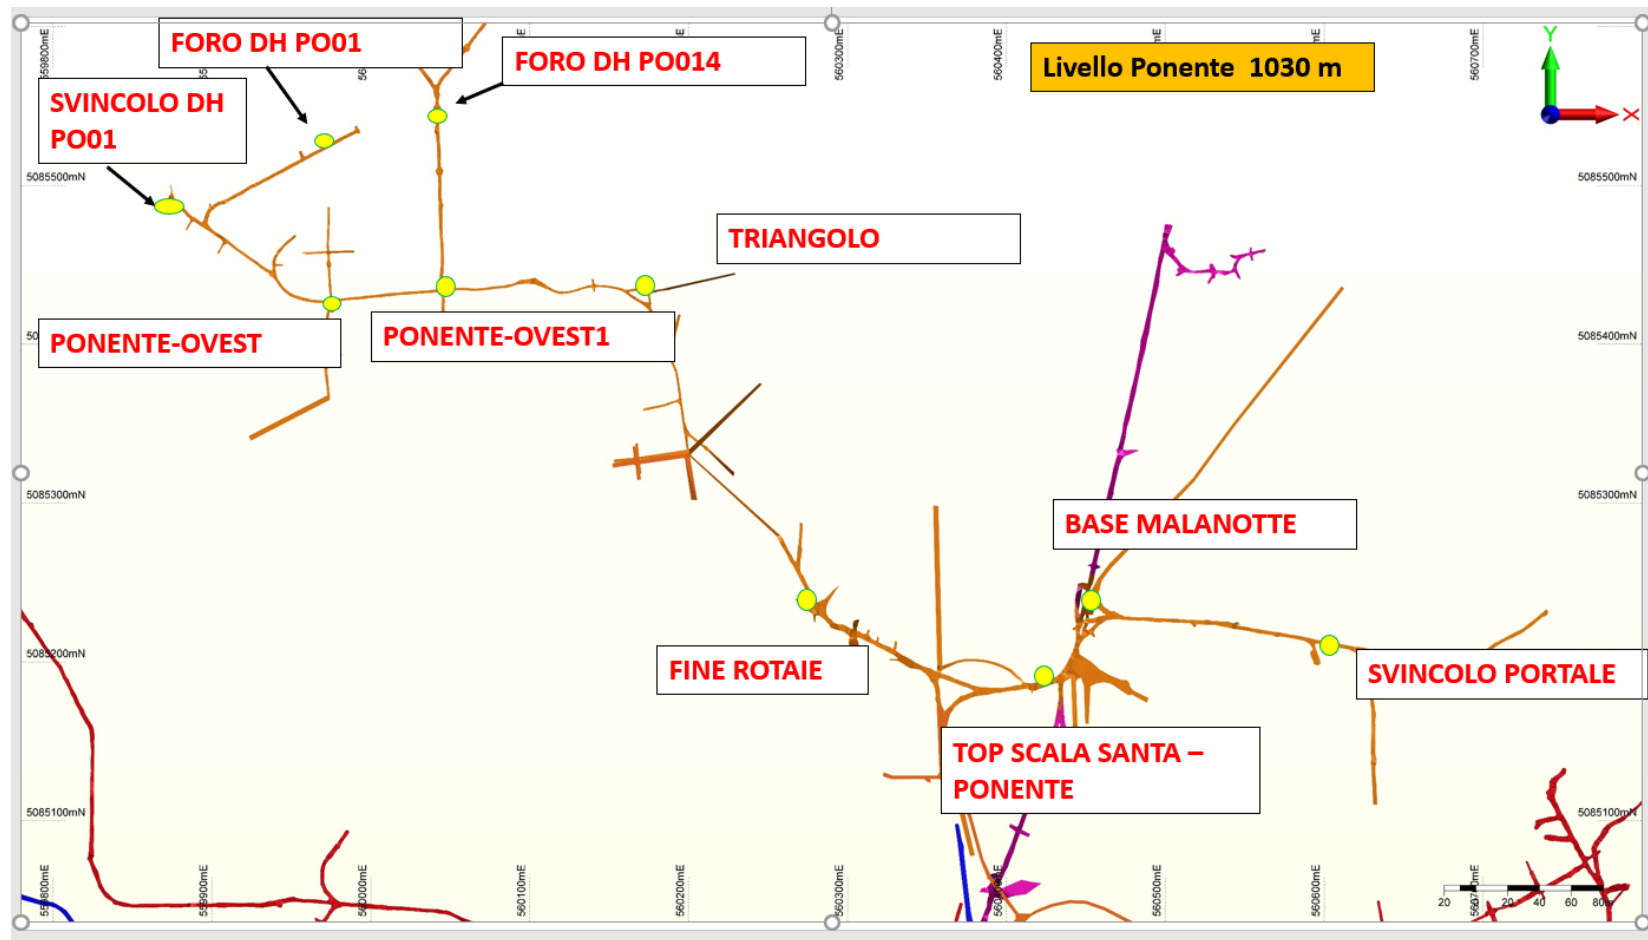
Planimetria della distribuzione dei dosimetri a livello Ponente
